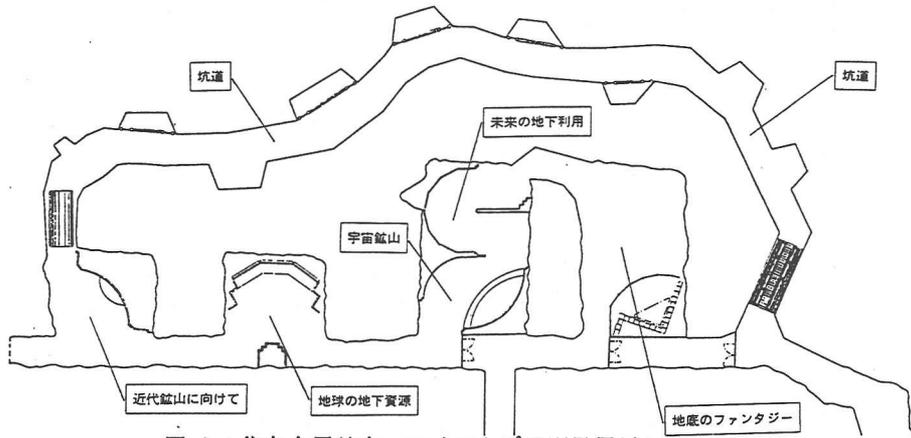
住友金属鉱山・マイントピア別子展示スペース平面図
